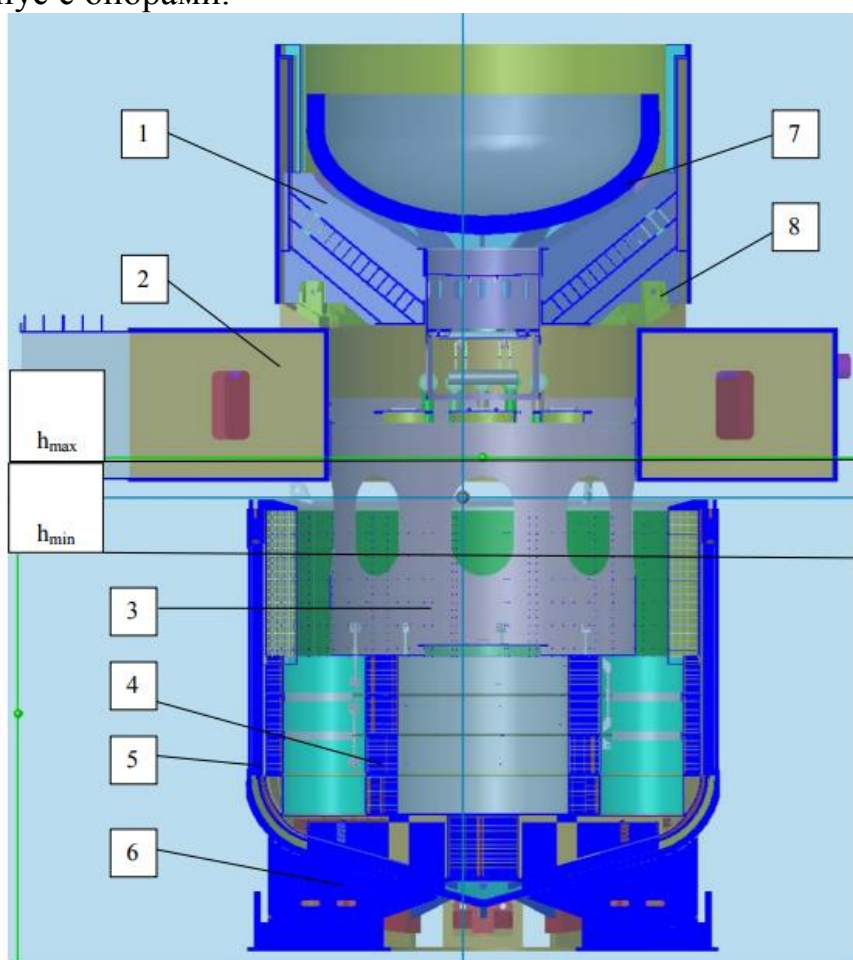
Внутреннее устройство УЛР: 1 - нижняя плита; 2 - ферма-консоль; 3 - площадка обслуживания; 4 - наполнитель; 5 - корпус УЛР; 6 - опора корпуса УЛР; 7 - корпус реактора; 8 - опора нижней плиты;  $h_{\max}$  - максимальный уровень воды;  $h_{\min}$  - минимальный уровень воды
